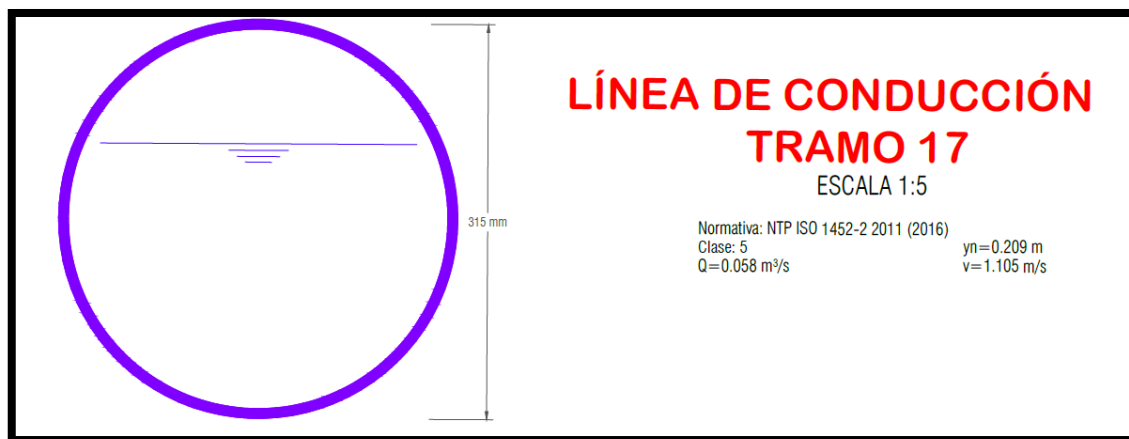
Sección típica de la tubería de PVC-U 250 mm, Tramo 17
